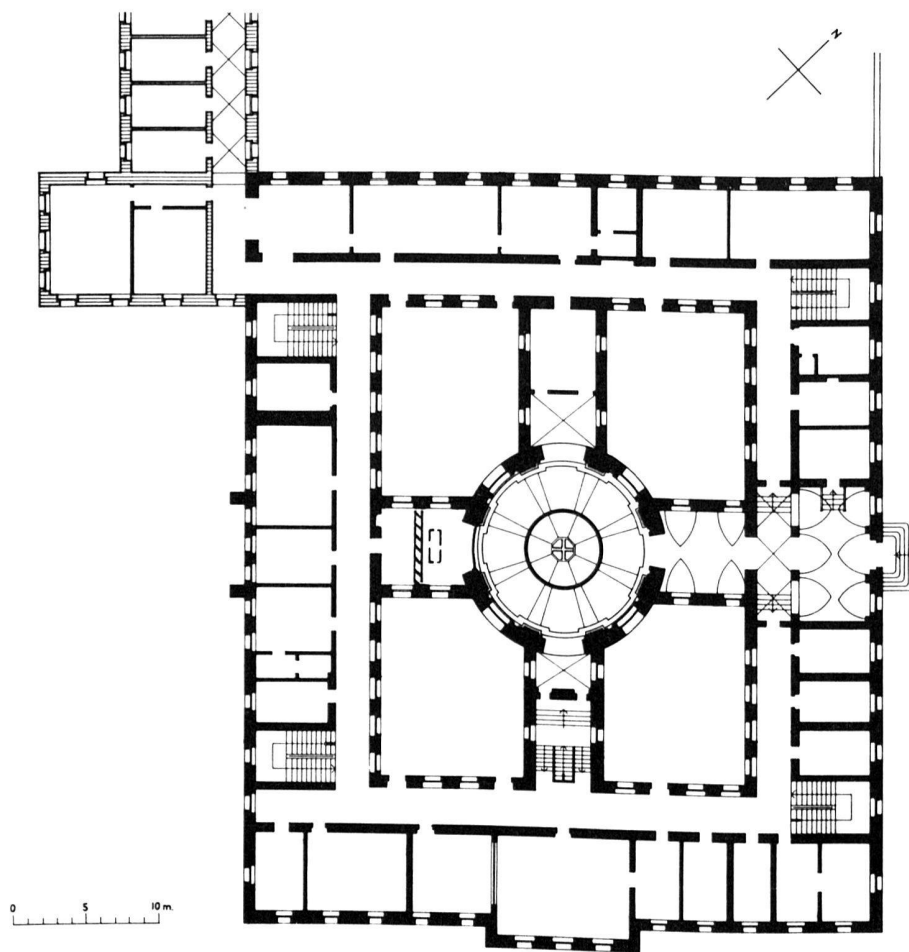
Fribourg/Ancien Hôpital des Bourgeois. Plan du rez-de-chaussée avec restitution de l'état original de la chapelle (1:500)
